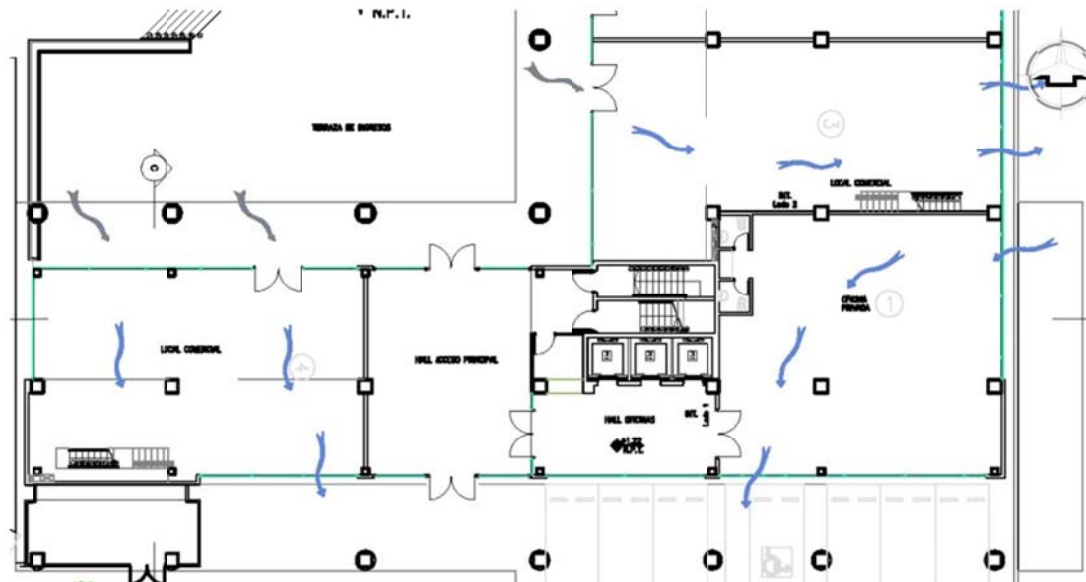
Ventilación cruzada en locales comerciales y efecto JET en oficina esquinera. Sector de la Planta baja.
